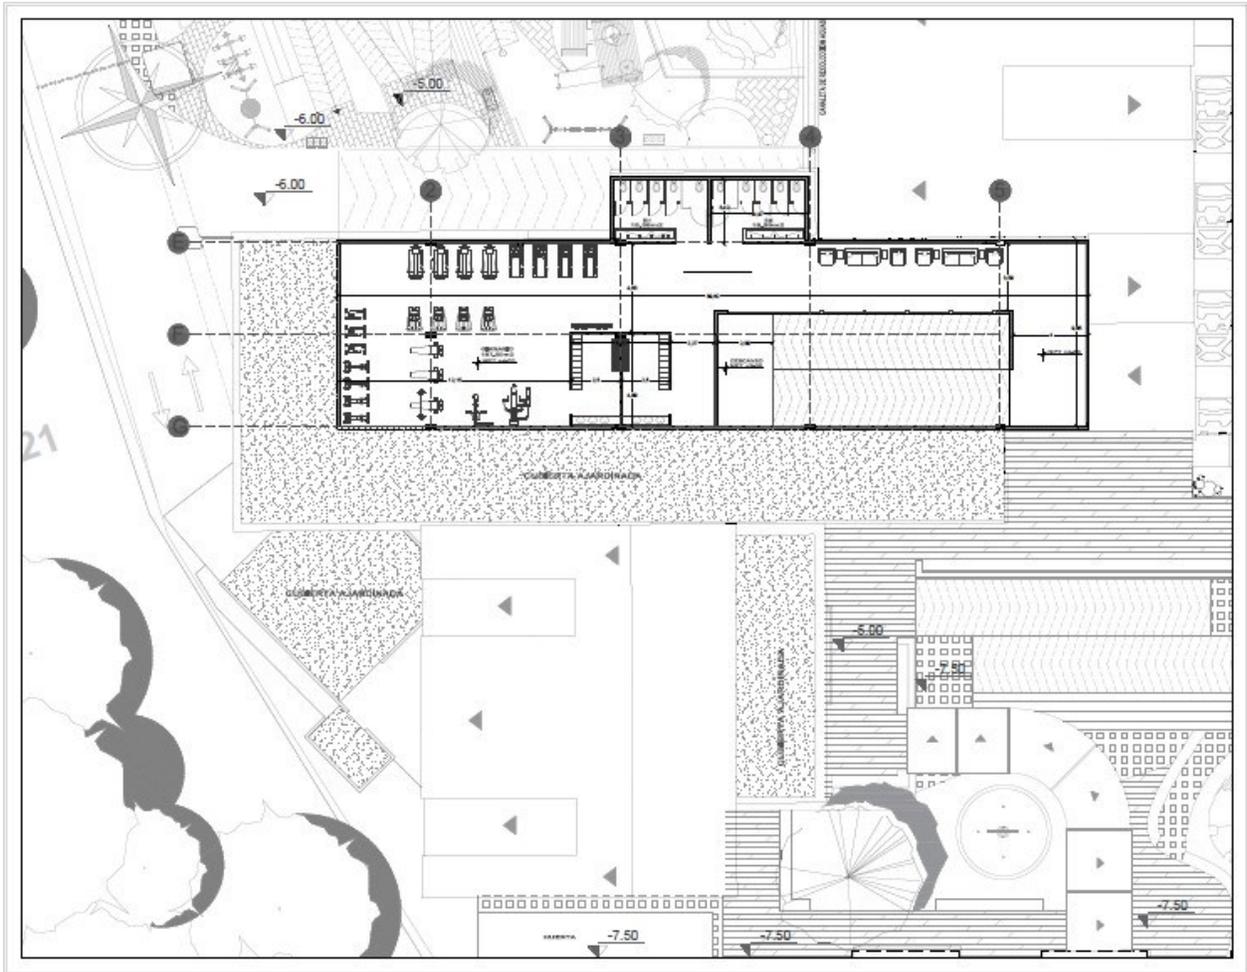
Planta Cubierta Edificación 1 (Rubiano, 2020)
